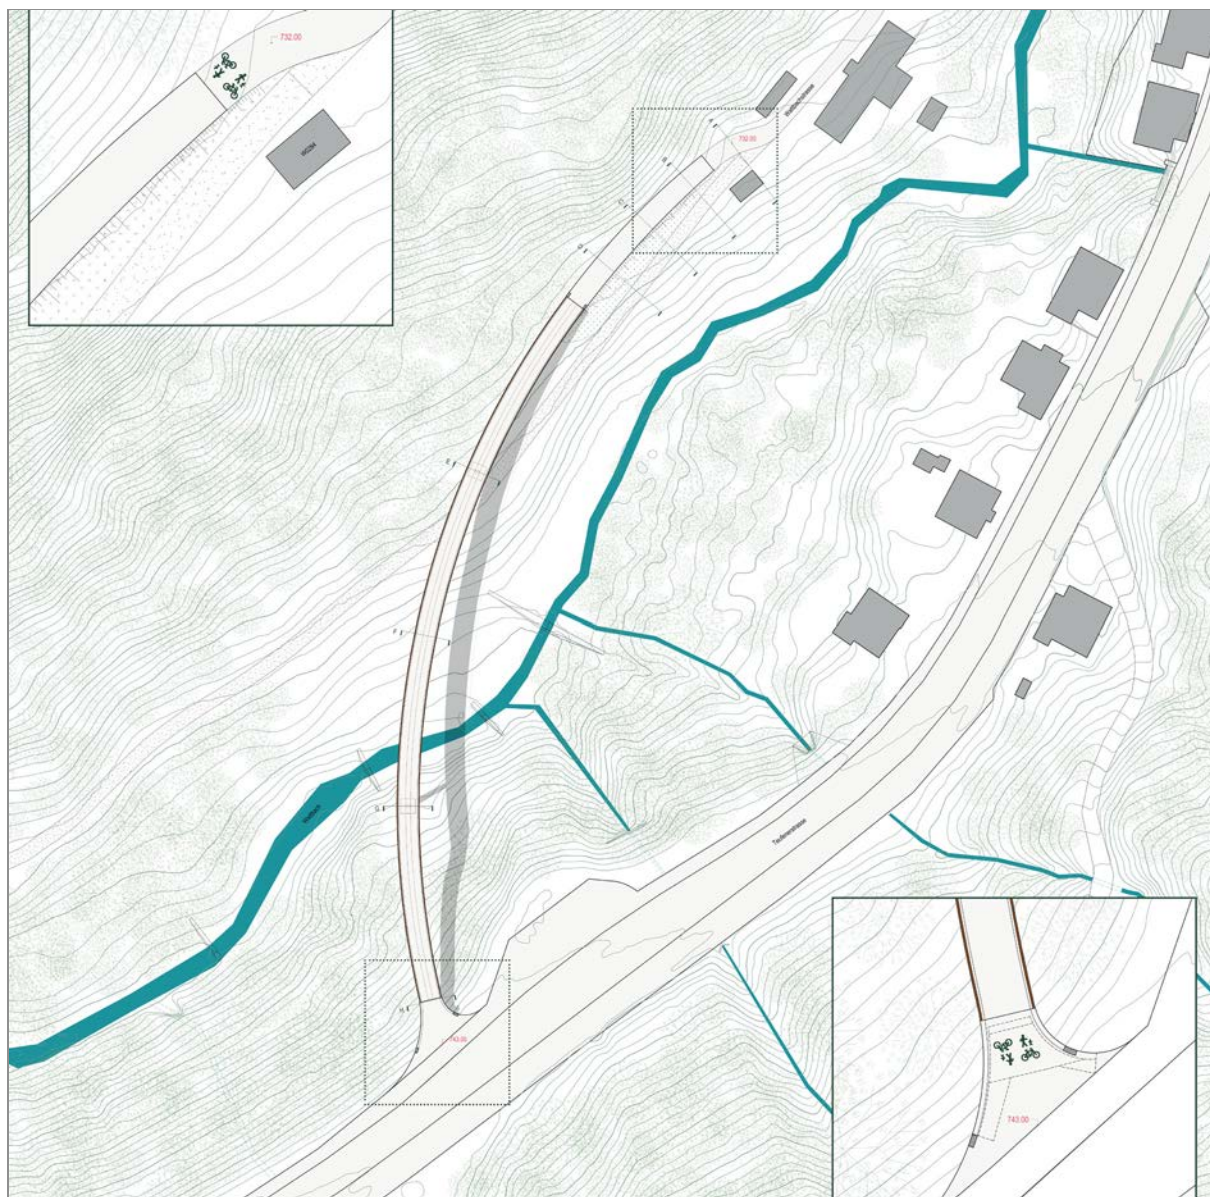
Situation und Grundrisse Anschlussbereiche A und B
